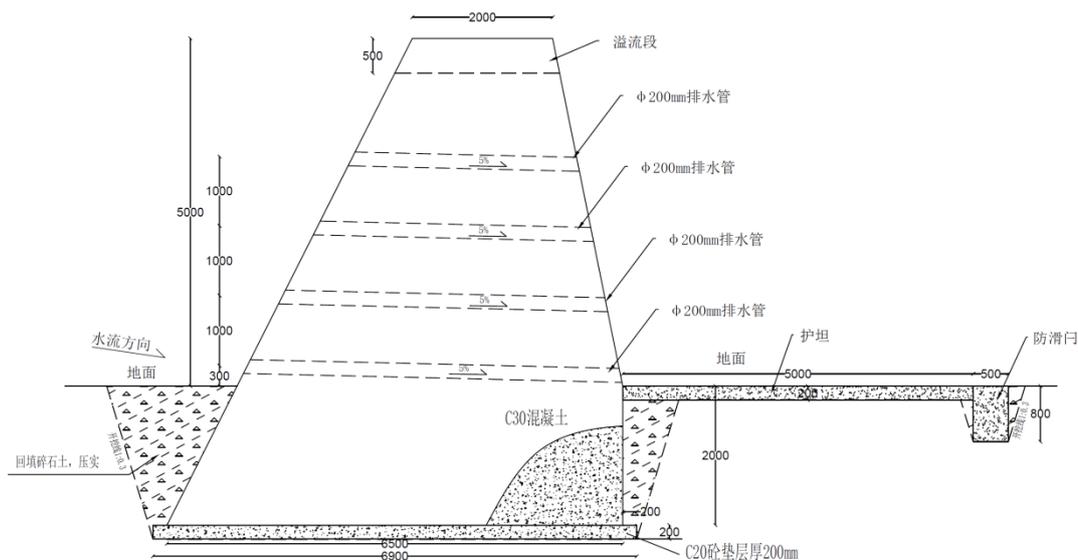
II 型拦挡坝断面图 (mm)
